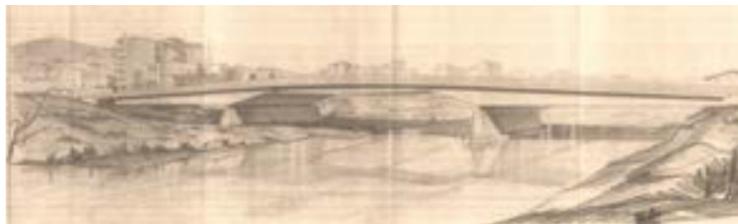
Vista Prospettica. Tavola n.3 - Progetto Esecutivo
